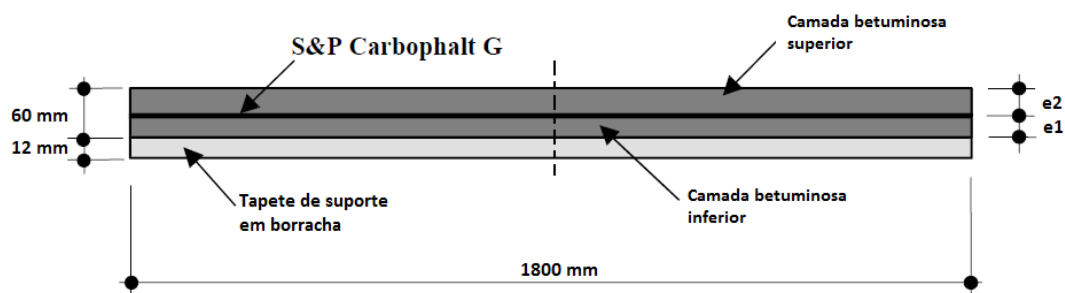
Secção longitudinal dos provetes em betão betuminoso (Sokolov 2006)
